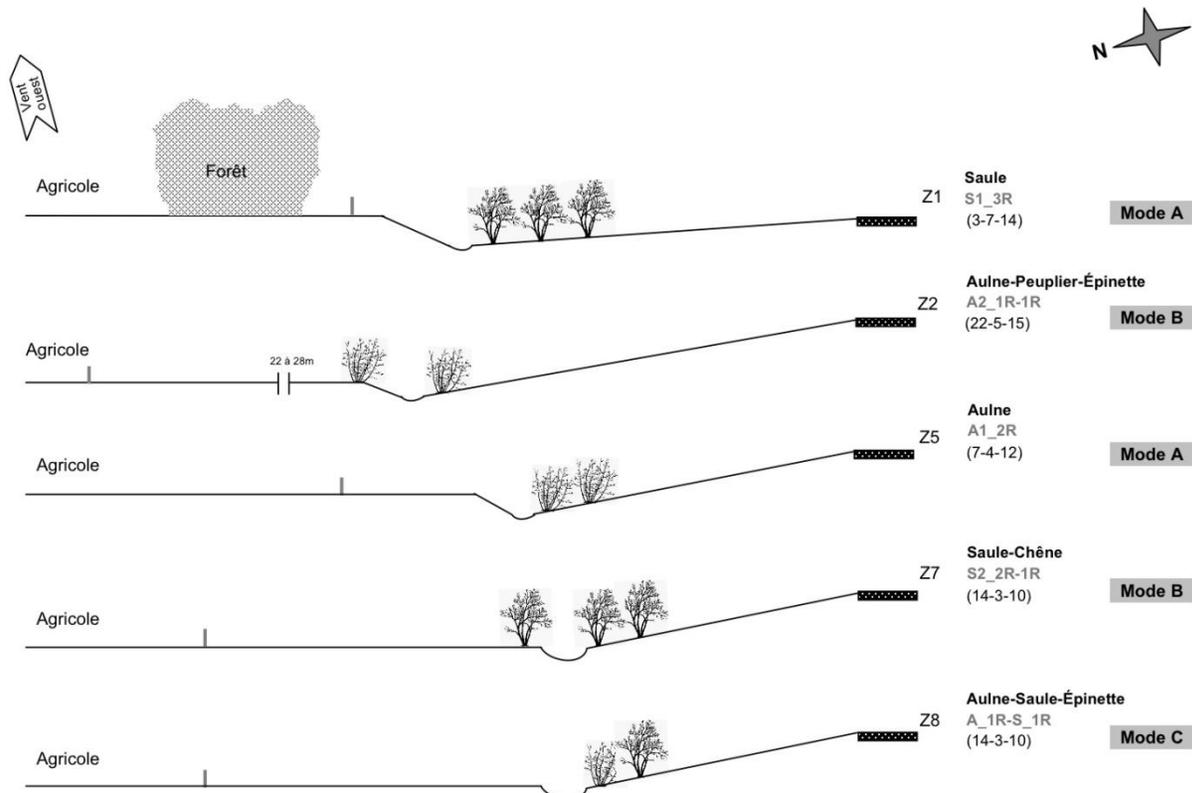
Coupes transversales des différentes zones de plantation du côté nord sur le site de Lachute
